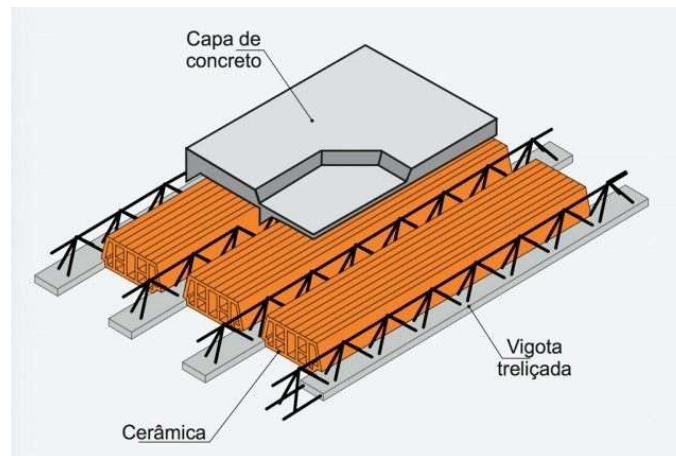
exemplo de Laje Pré-moldada treliçada com lajota (Pinterest).
